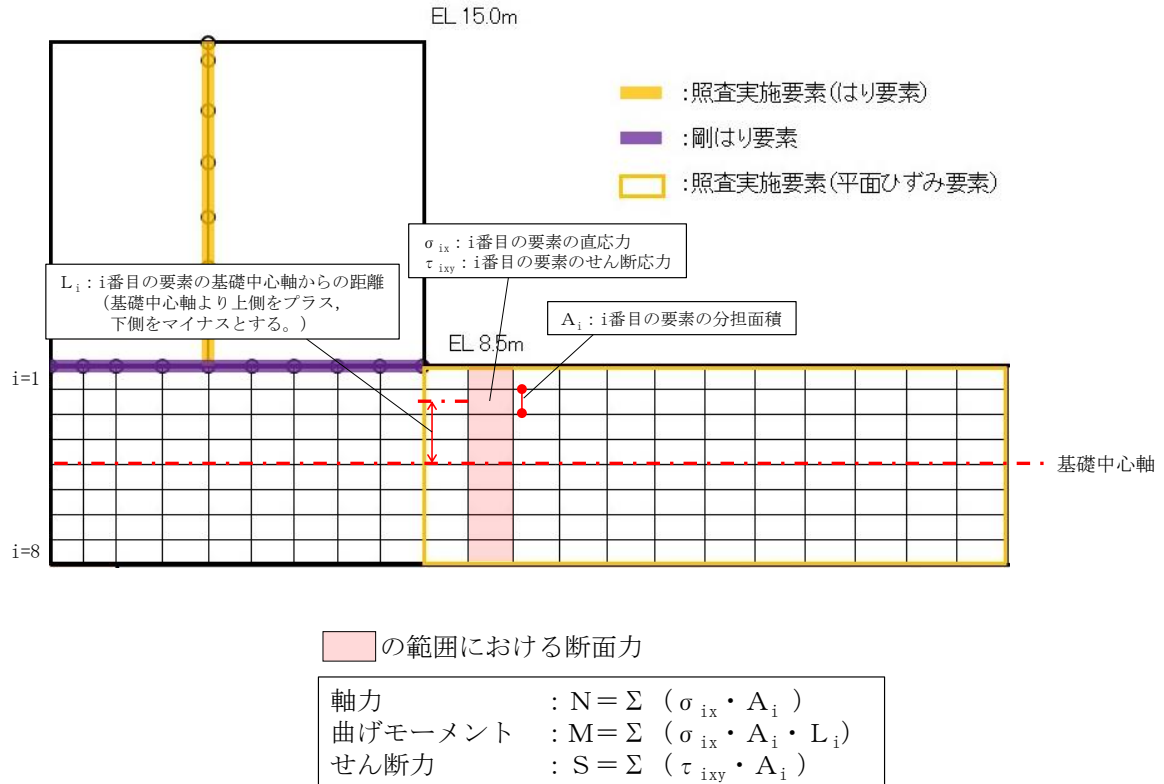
漂流物対策工基礎スラブの断面力算定方法
